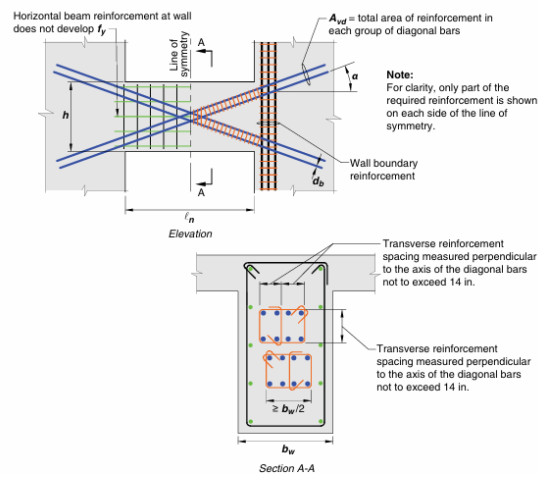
Armado Diagonal con Confinamiento Individual en las Diagonales [Figura 18.10.7a ACI318-19]
